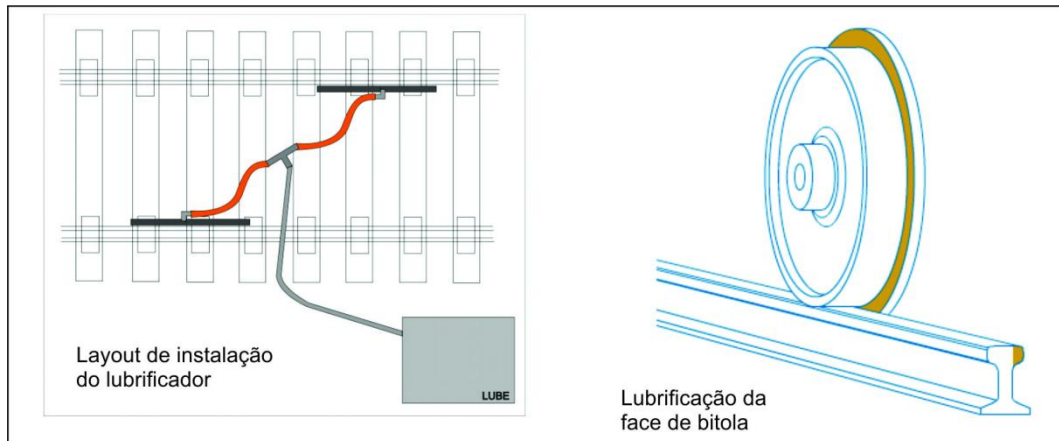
Layout de instalação de lubrificadores da face de bitola.
